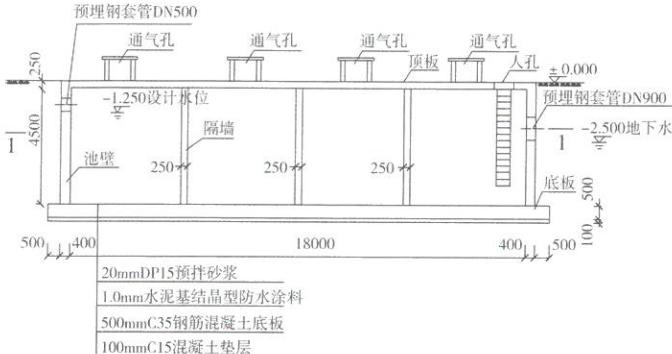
水池剖面图（标高单位：m；尺寸单位：mm）
